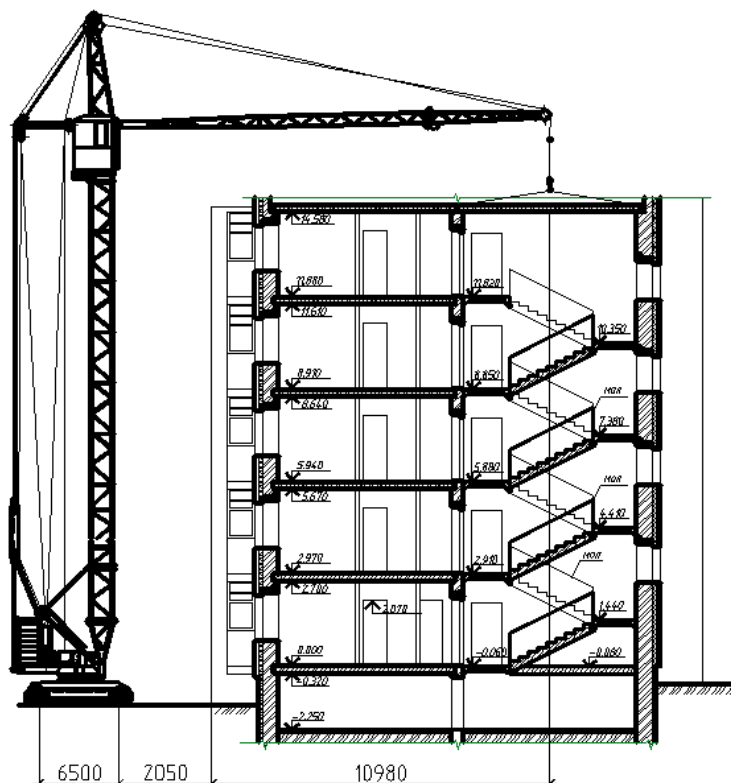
Монтаж плиты перекрытия краном МСК-10-20
